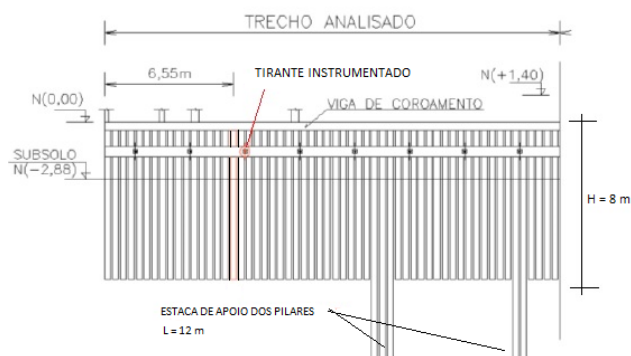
Configuração do Trecho de Cortina Instrumentado.
